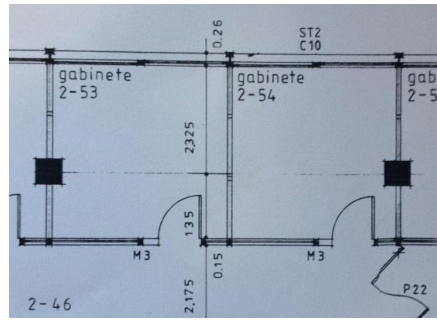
Planta tipo de dois gabinetes do 2º piso do Pavilhão de Engenharia Civil e Arquitectura na Fachada Este
